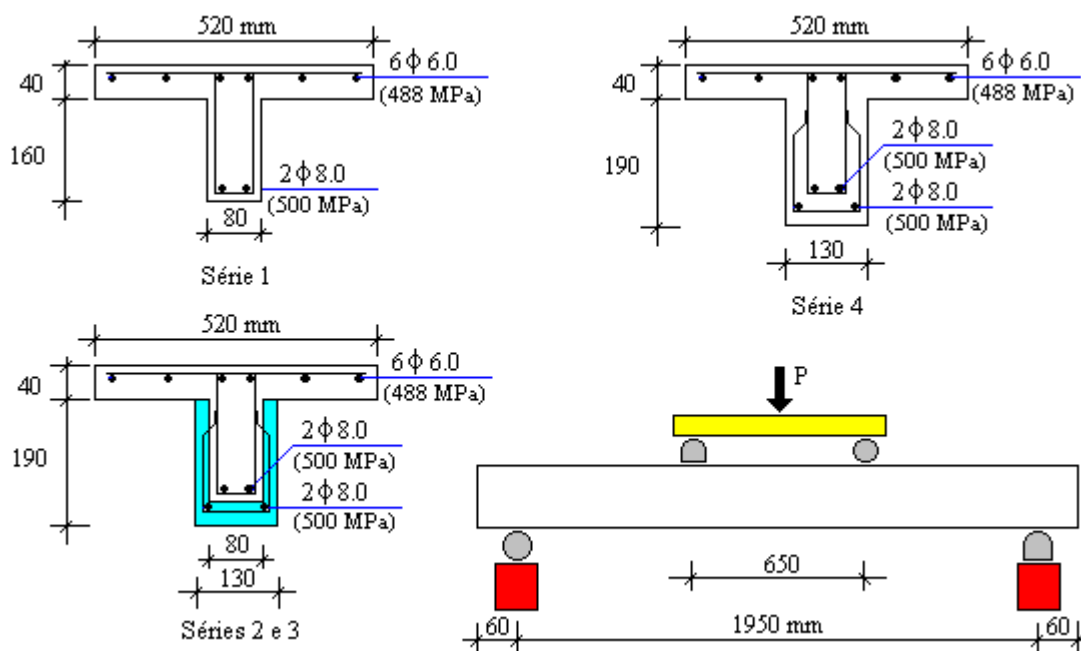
Seção Transversal das Vigas e Esquema do Ensaio
